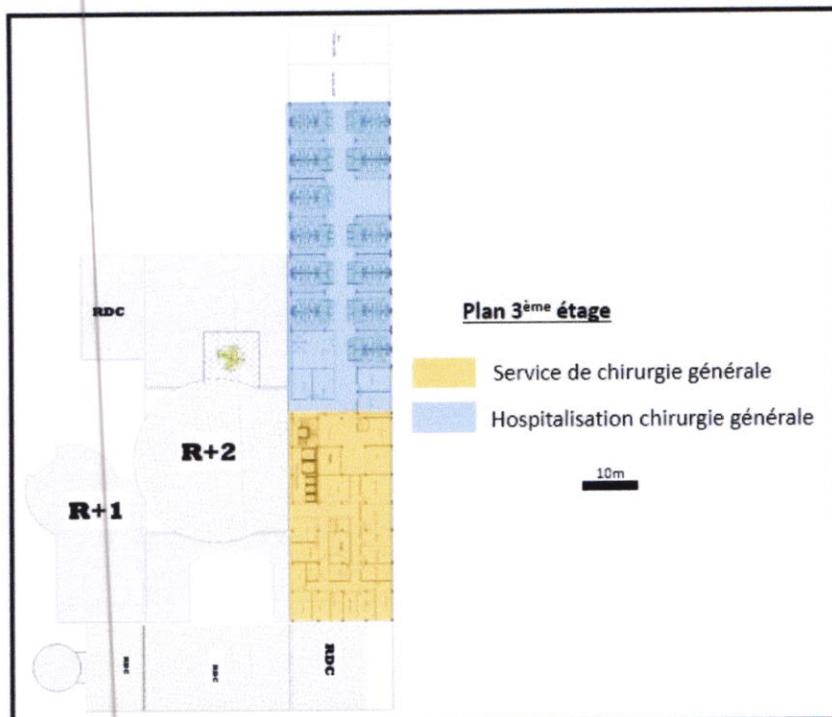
Plan 3<sup>ème</sup> étage-Agencement des unités fonctionnelles Source auteurs.
